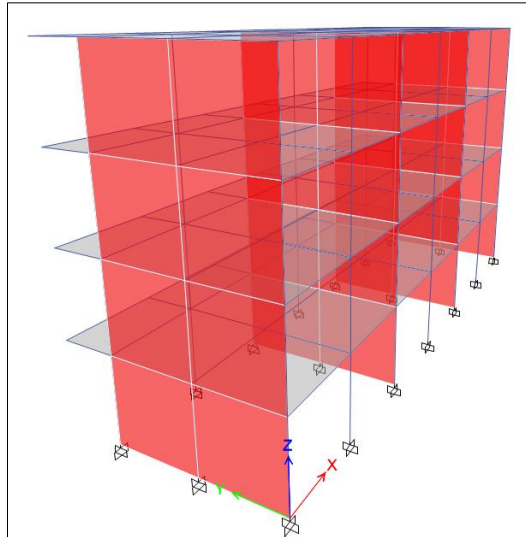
Vista conjunta posterior y lateral del modelo estructural 3D
